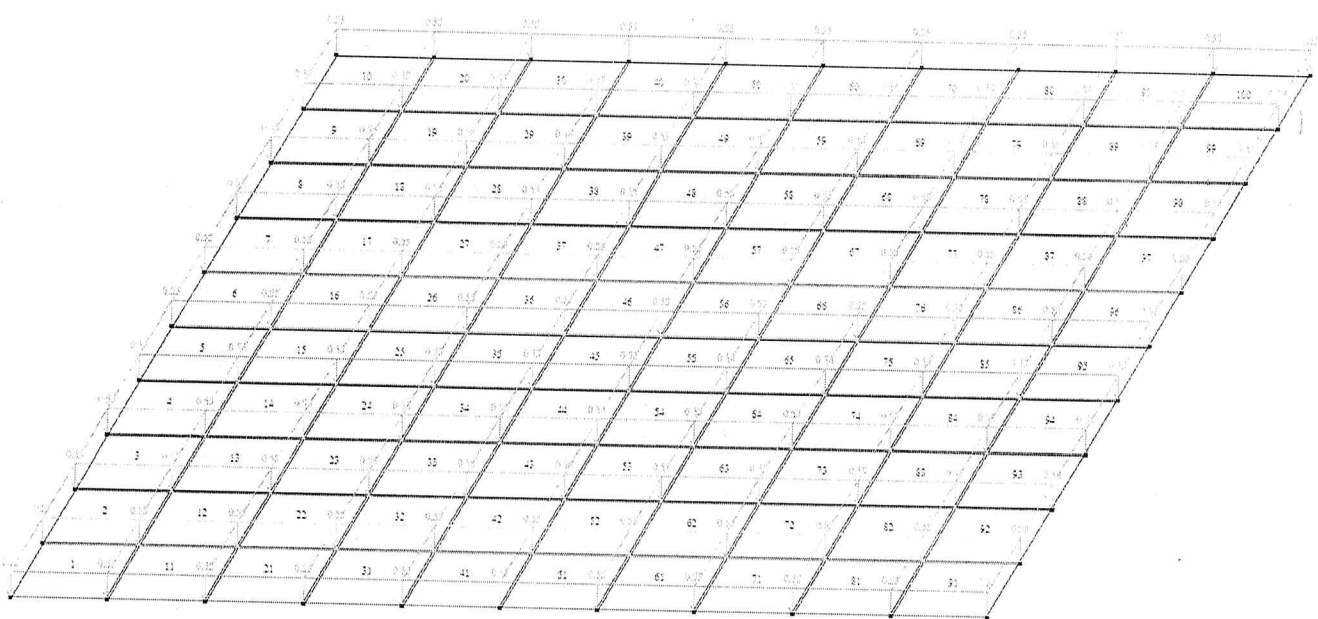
Нагрузка на плиту перекрытия лифтовой шахты от собственного веса плиты перекрытия
